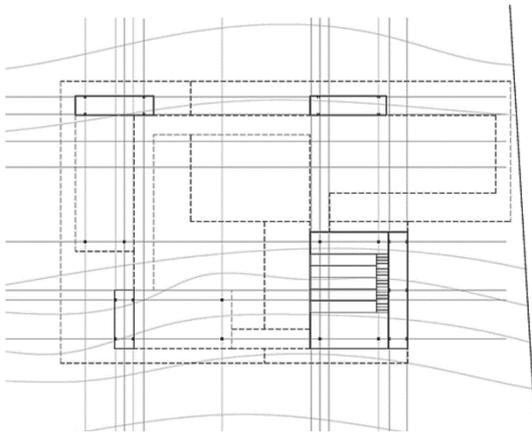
| Planta Centro Interpretativo. Eixos Estrutura
